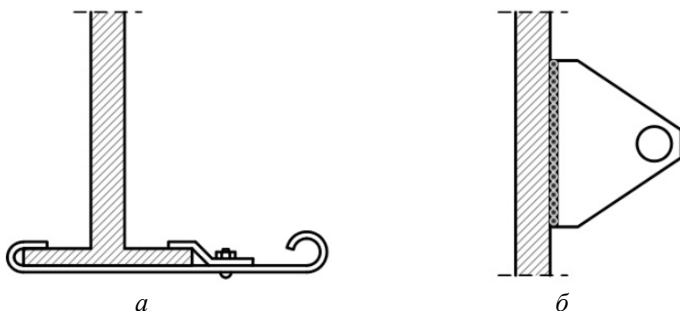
Схема выполнения концевого крепления к металлическим элементам строительных конструкций с помощью:
